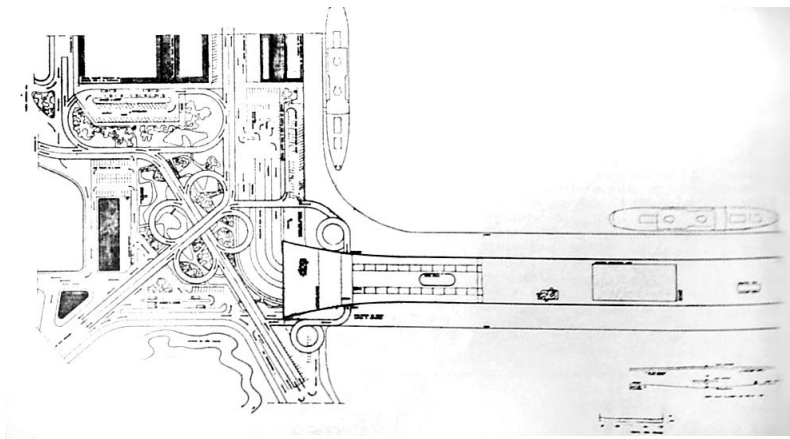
Planta de situação com o trevo da Praça Mauá. Fonte: Revista Habitat, 1955.
